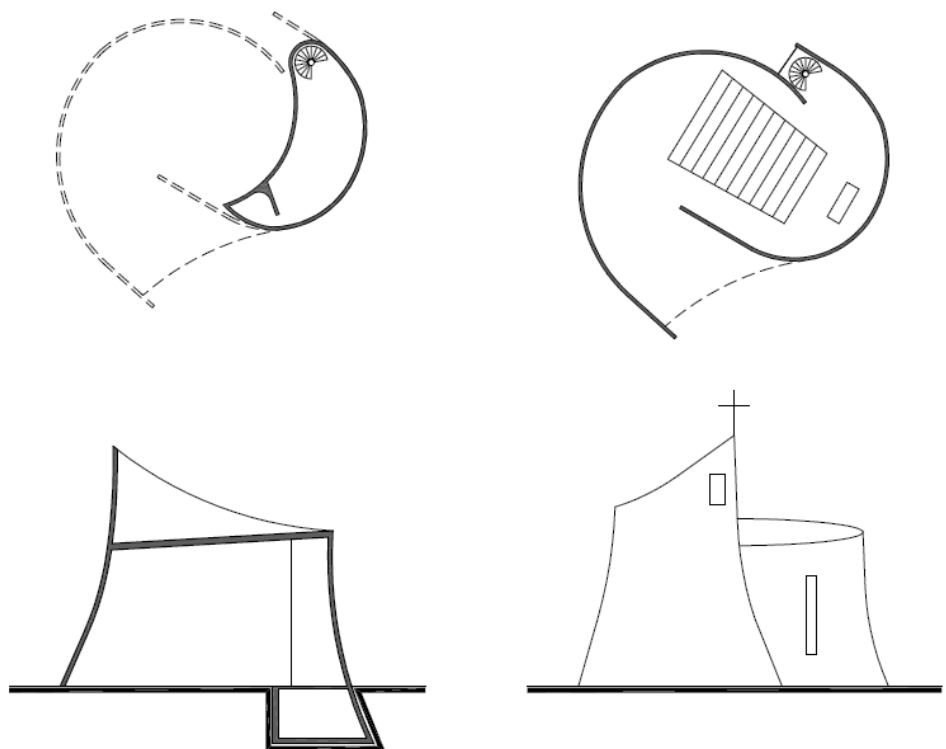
| Capela do Palácio da Alvorada. Plantas baixas, corte e elevação
